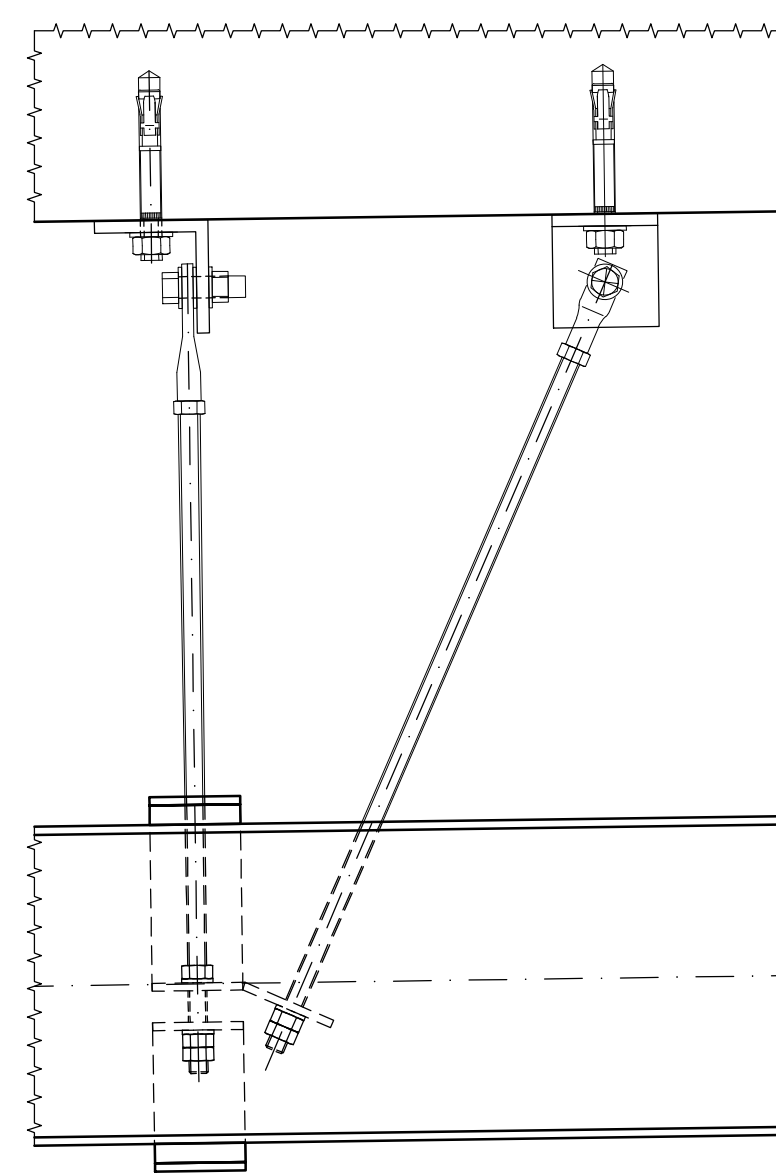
DETAIL UKOTVENÍ POTRUBÍ K NOSNÉ KONSTRUKCI
